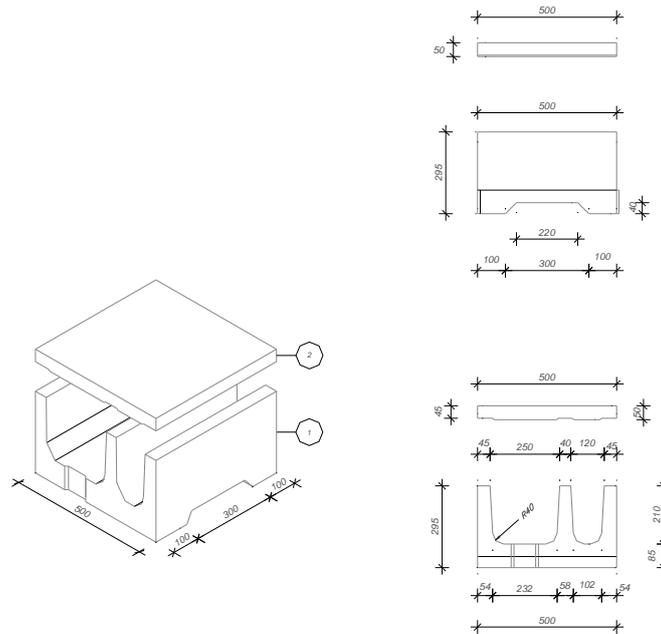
Dettaglio in pianta e sezione testa embrici su piattaforma ferroviaria
